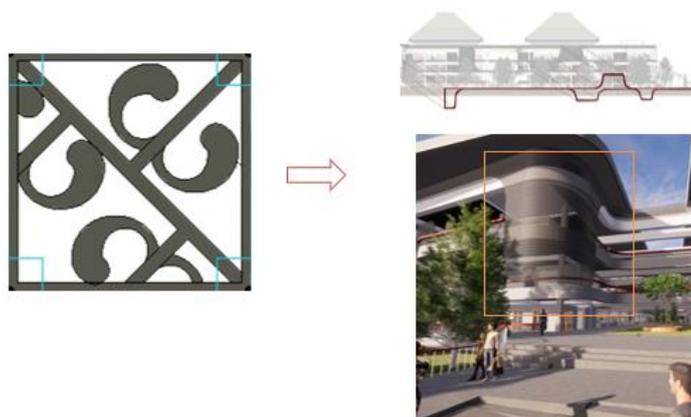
Penerapan Konsep Locality pada Fasad Bangunan
